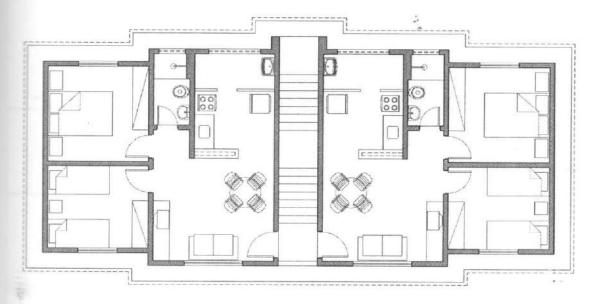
Planta do pavimento tipo do Empreendimento A. (Fonte: SAMPAIO, 2010)
